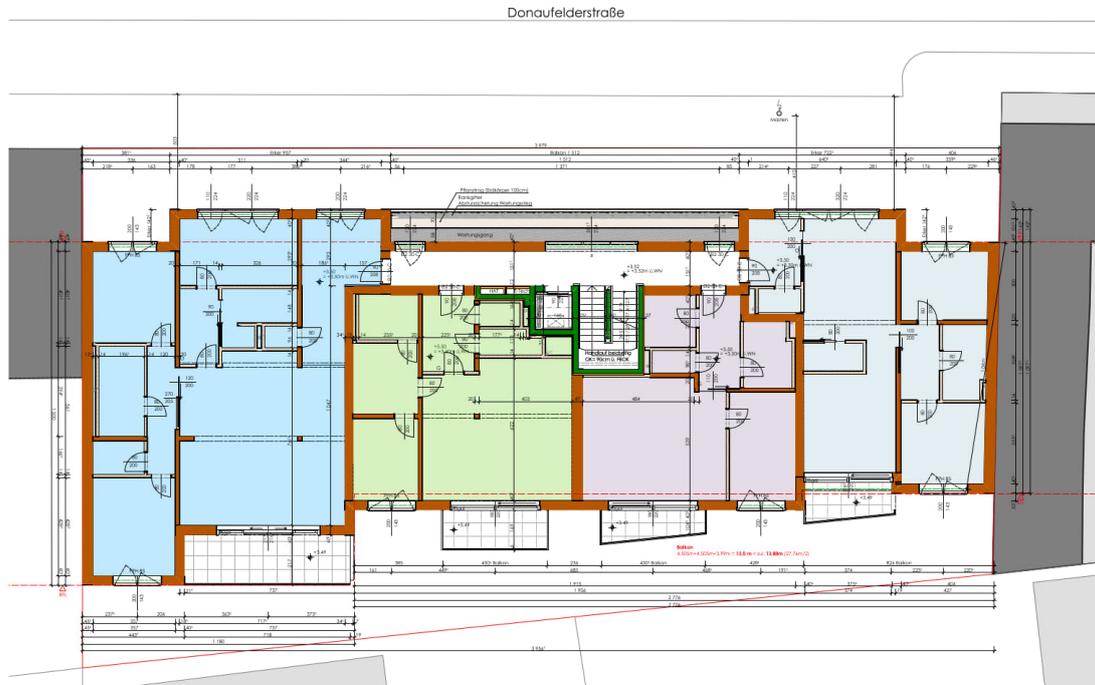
Grundrissdarstellung Regelgeschoß 22. Donaufelder Straße 174-178
